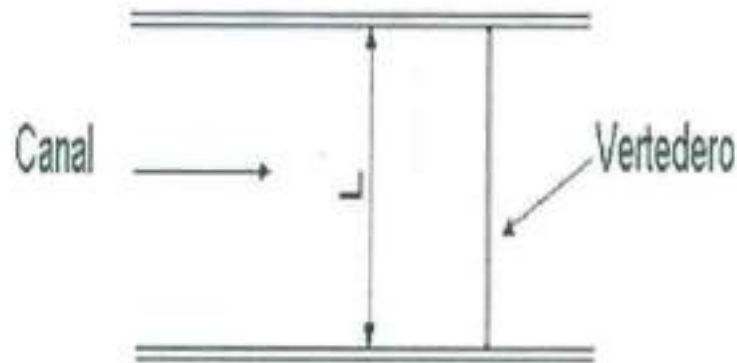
Vista en planta de un vertedor rectangular sin contracciones.
